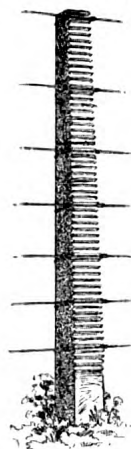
Betonpfeiler mit Einkerbungen zum Einlegen von Zaumdrähten.
